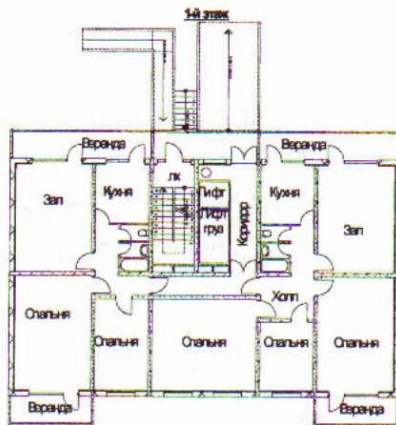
Односекционный жилой дом (3-4) комнатными квартирами. План 1-го этажа
